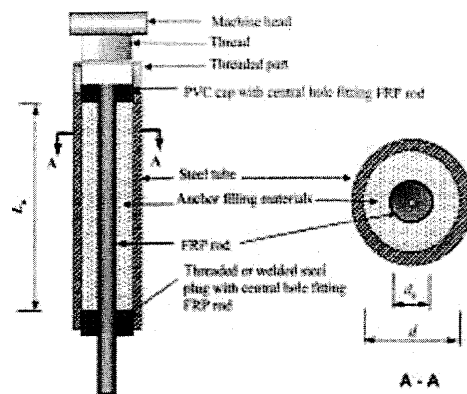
b: Afferraggio delle barre di FRP proposto dalle ACI 440.3R-04
